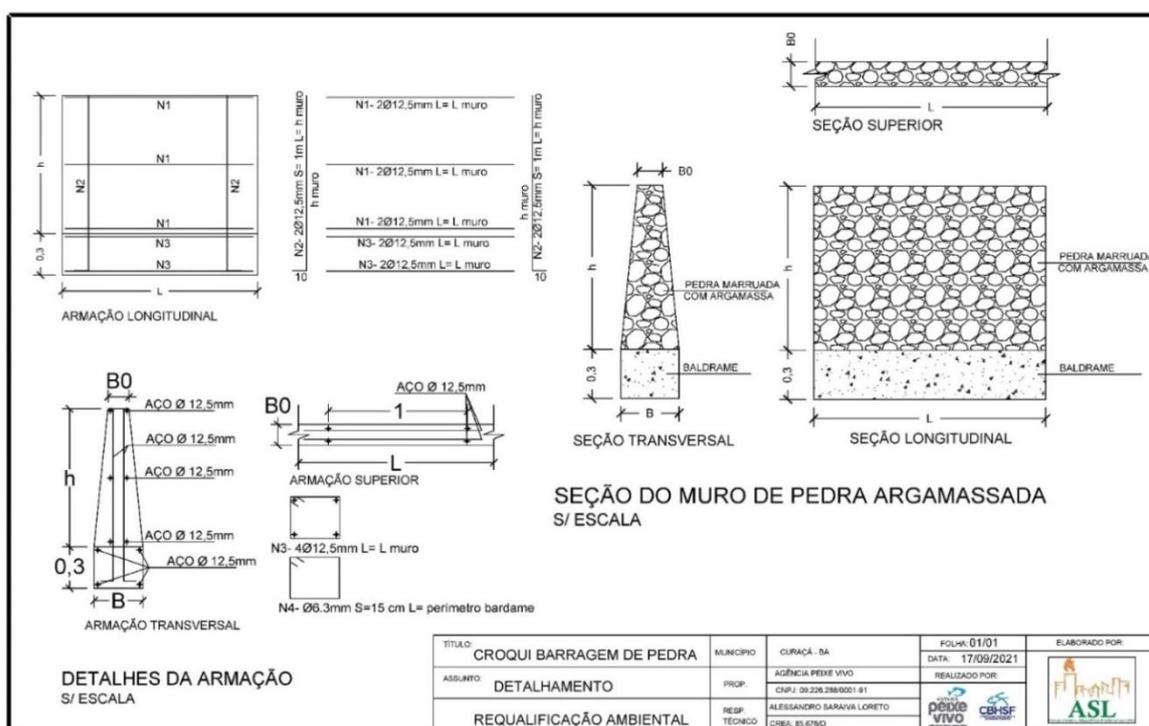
Croqui do modelo de construção da barragem de pedra argamassada.
